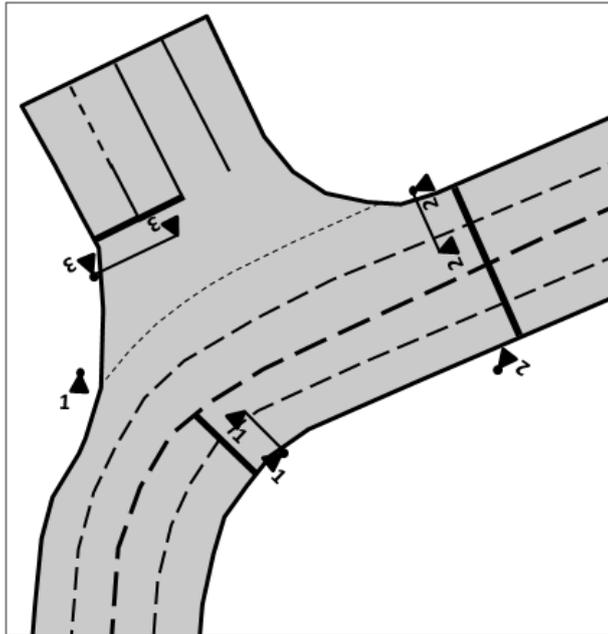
Signallageplan A159 Planstraße X/ Zufahrt Parkflächen THE MIRAI
